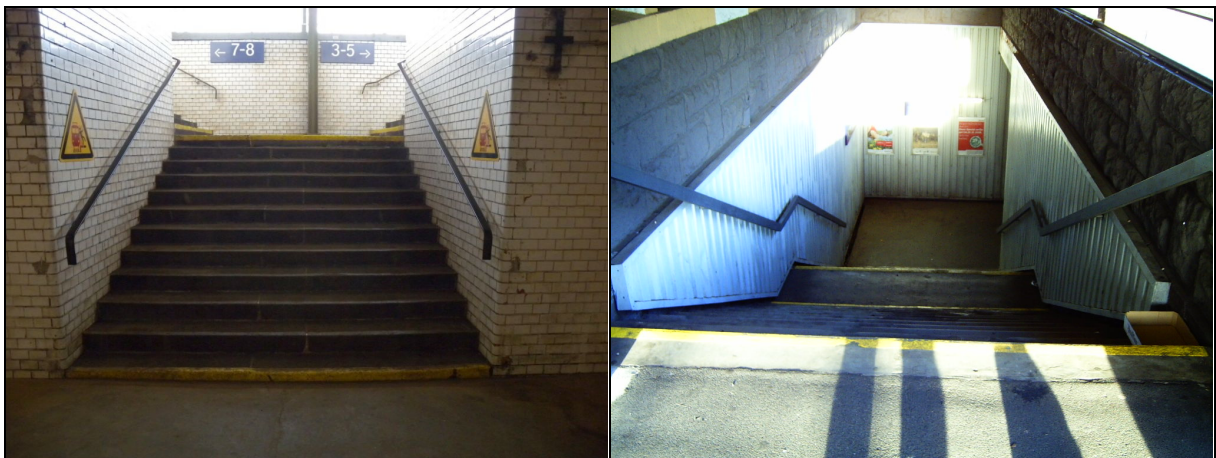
Nicht barrierefrei erreichbare Bahnsteige und Bahnsteigunterführungen in Bebra (links) und in Schwalmstadt-Treysa (rechts)
